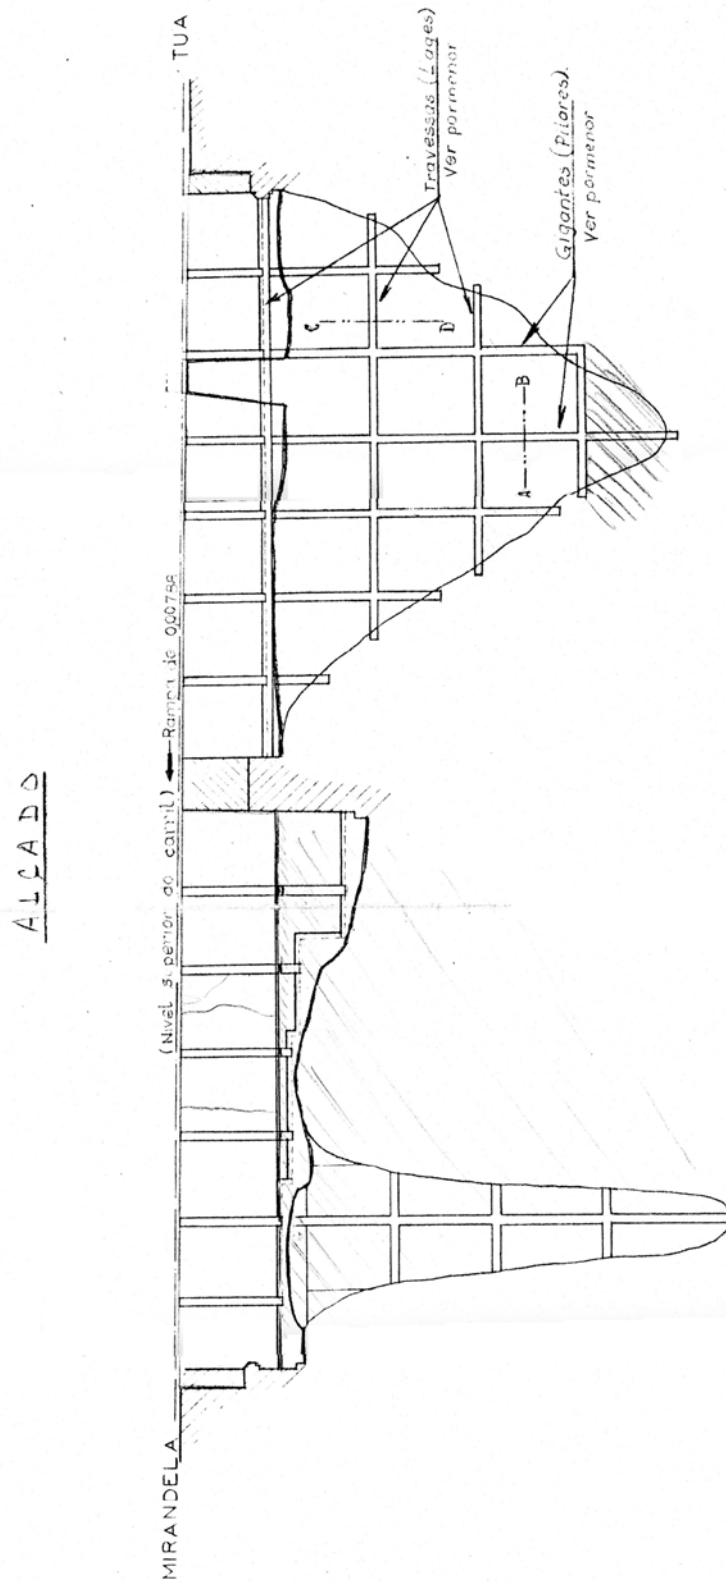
Viaduto das Fragas Más – estrutura de betão armado – alçado (fonte: REFER)
